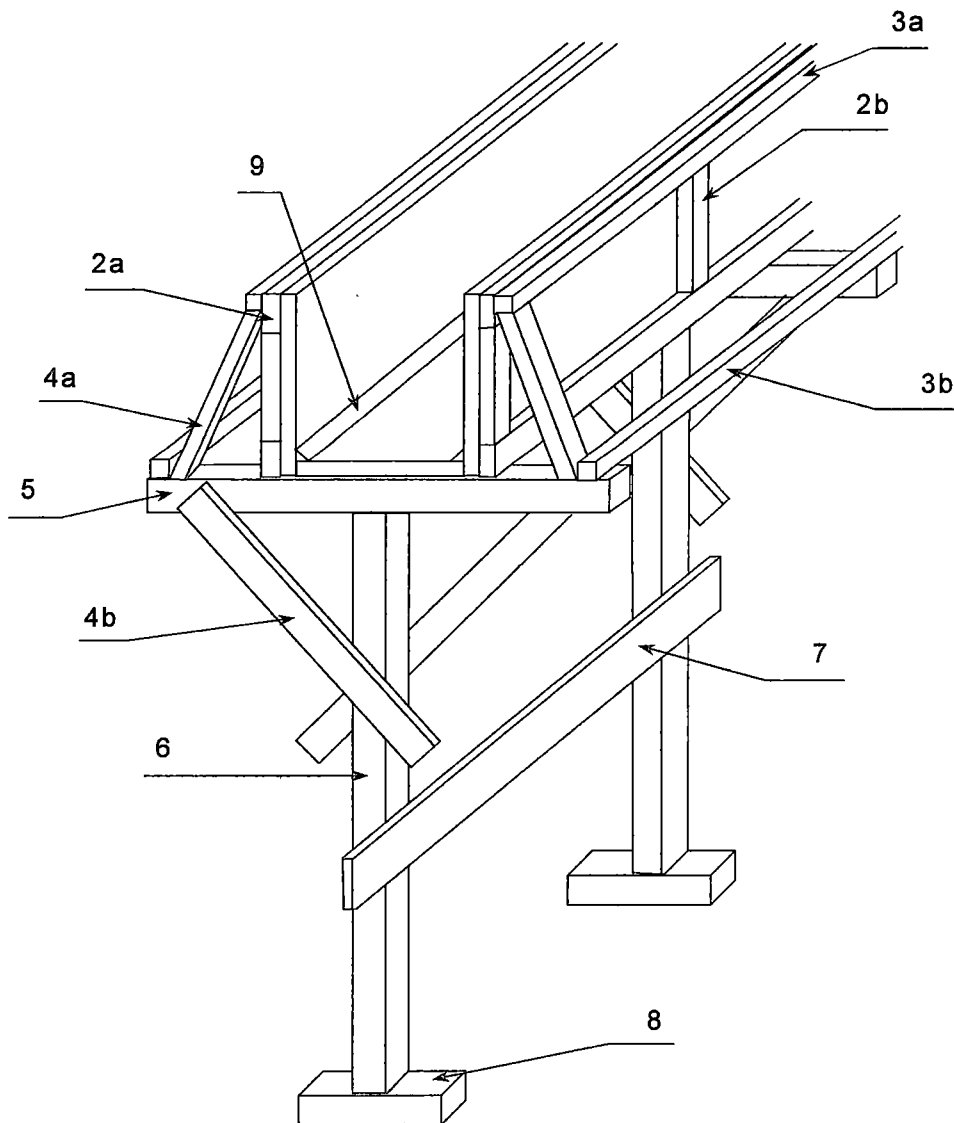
Encofrado de viga de concreto expuesto.
